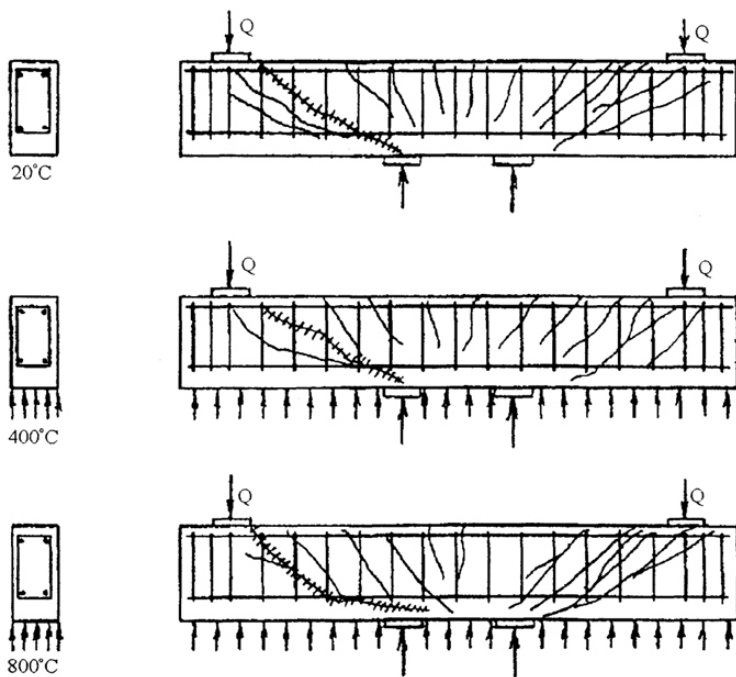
Характер развития наклонных трещин при разрушении балок прямоугольного сечения с укороченными хомутами
